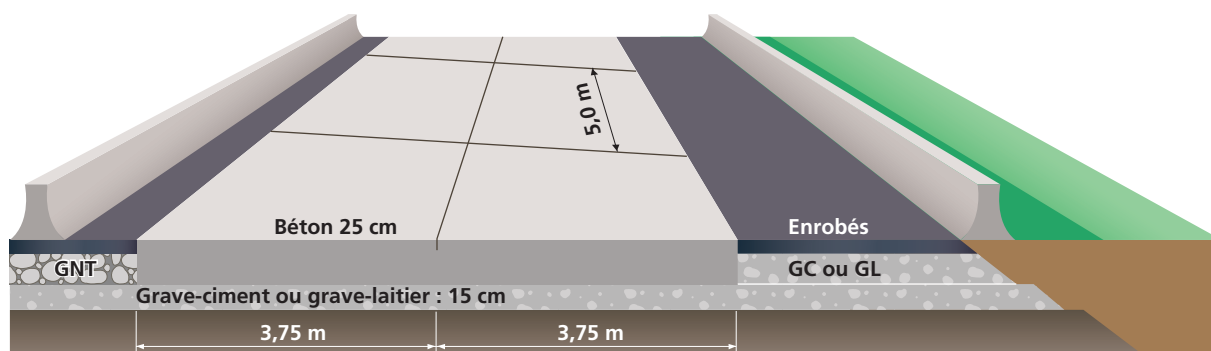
exemple de profil en travers d'une chaussée béton dite « californienne ».
